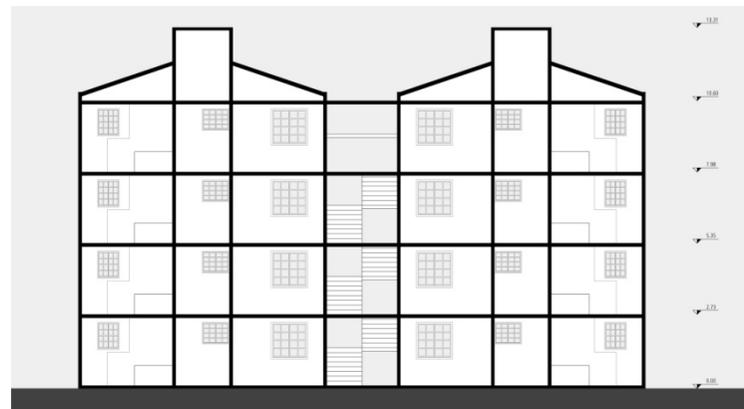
Planta de corte – Conjunto Habitacional União da Juta.
